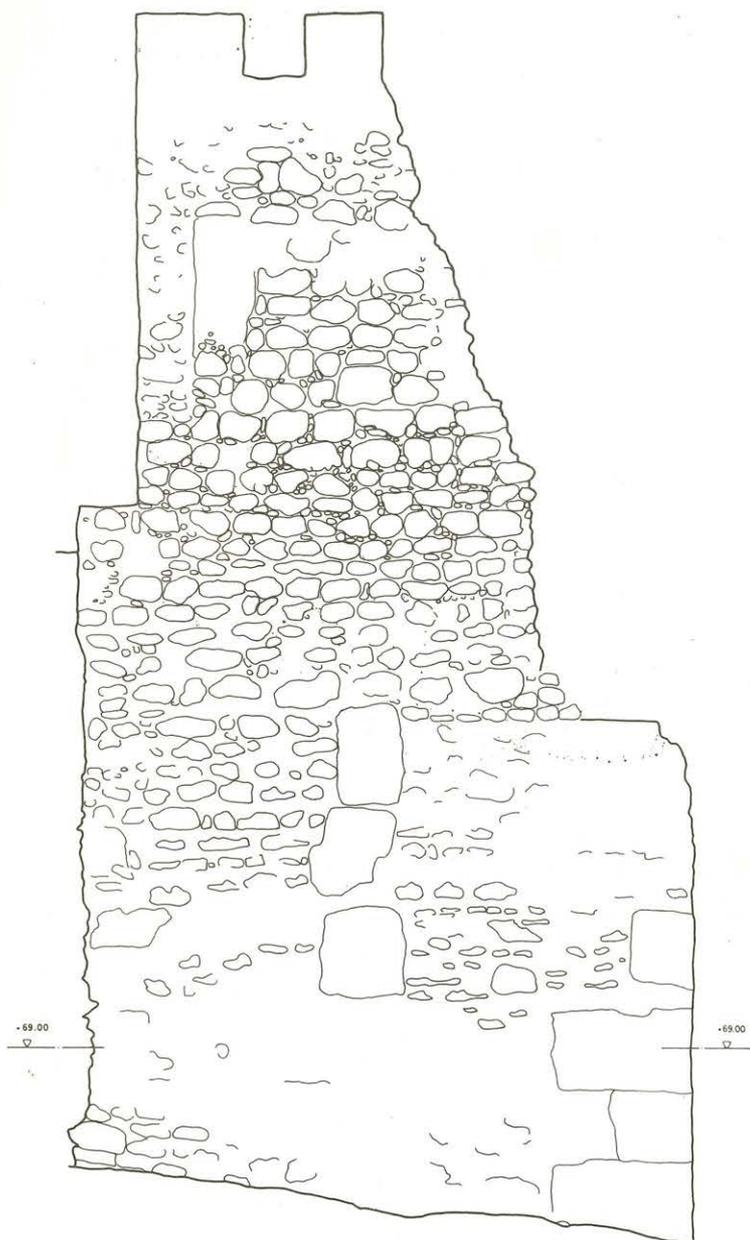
Alzado sur de la Torre C. Ibidem autor.
